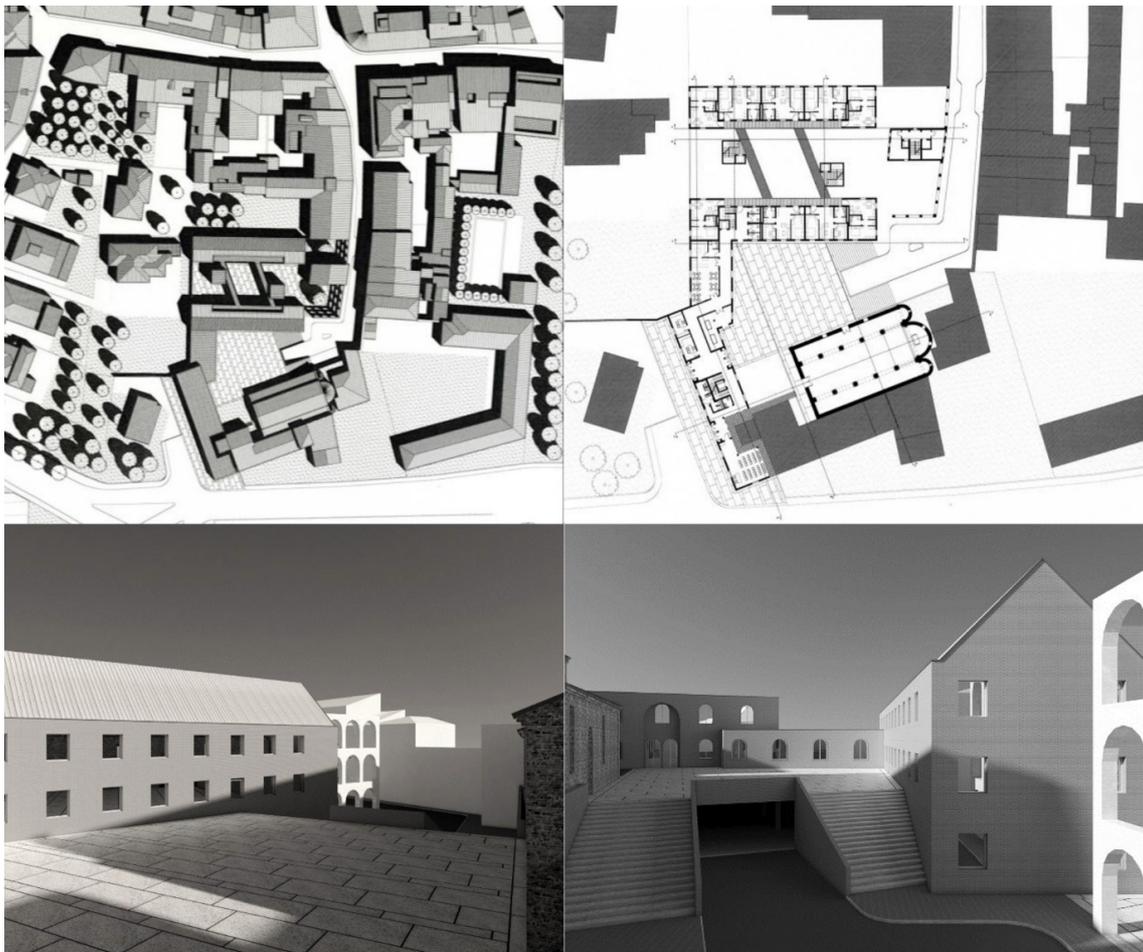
, 8, 9, 10 | Proposta di riqualificazione dell'area di San Silvestro a Vicenza. Planivolumetrico di progetto, planimetria di progetto, vista della nuova piazza il cui selciato corrisponde alla quota del pavimento della chiesa, veduta dell'accesso dalla contrada allo spazio ipogeo destinato a parcheggio. Come avveniva in passato, Contrà San Silvestro torna a concludersi nell'architettura del monastero benedettino. Progetto elaborato dallo studente Stefano Boscaro, corso di Composizione Architettonica e Urbana 2.
